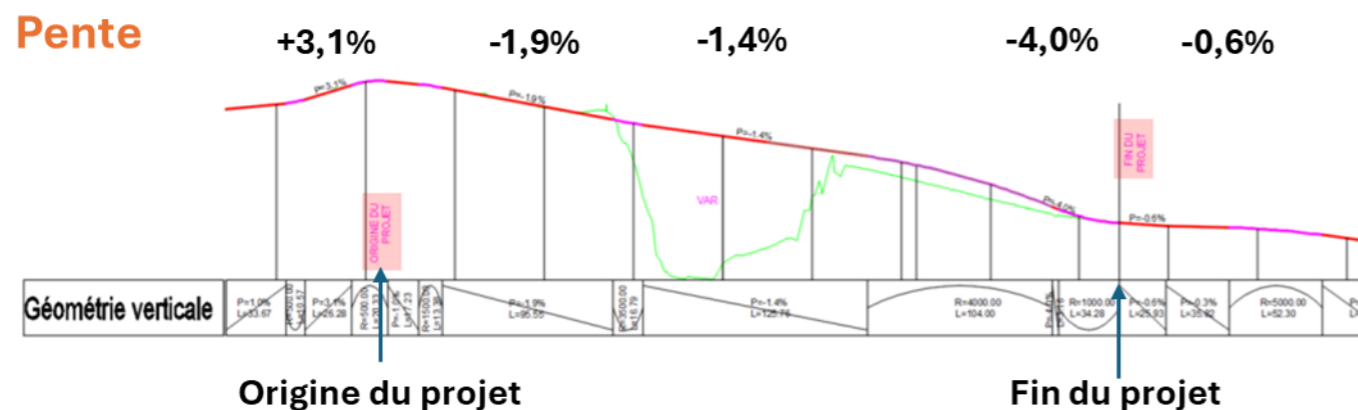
Profil en long de la RD6202 au droit du futur ouvrage de la Trinité
